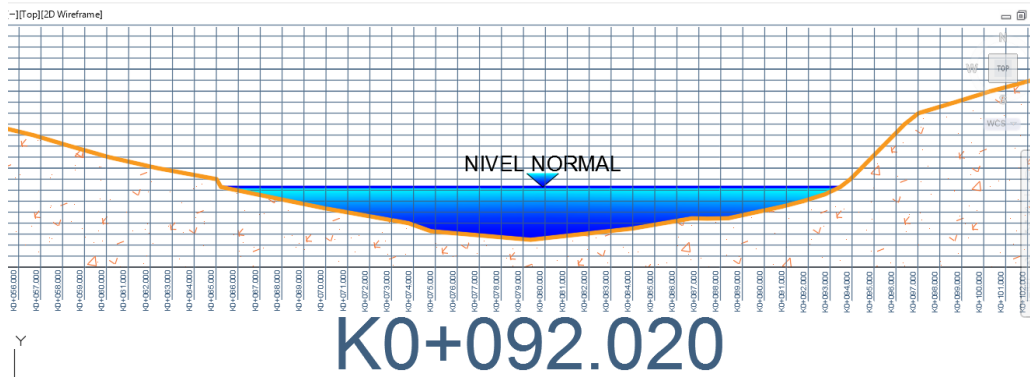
Sección transversal del eje el puente, Software AutoCAD. Fuente: Propia.
